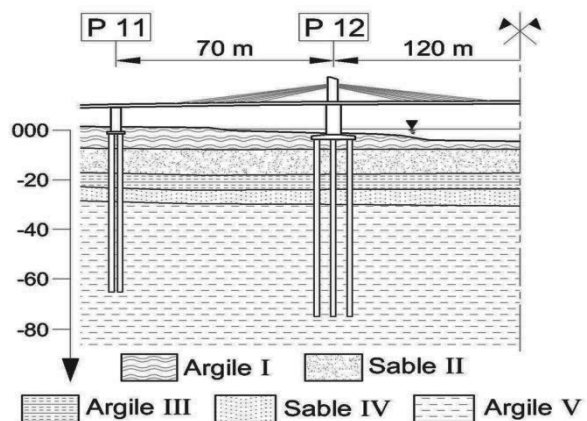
Demi-profil longitudinal de l'ouvrage et coupe géologique
